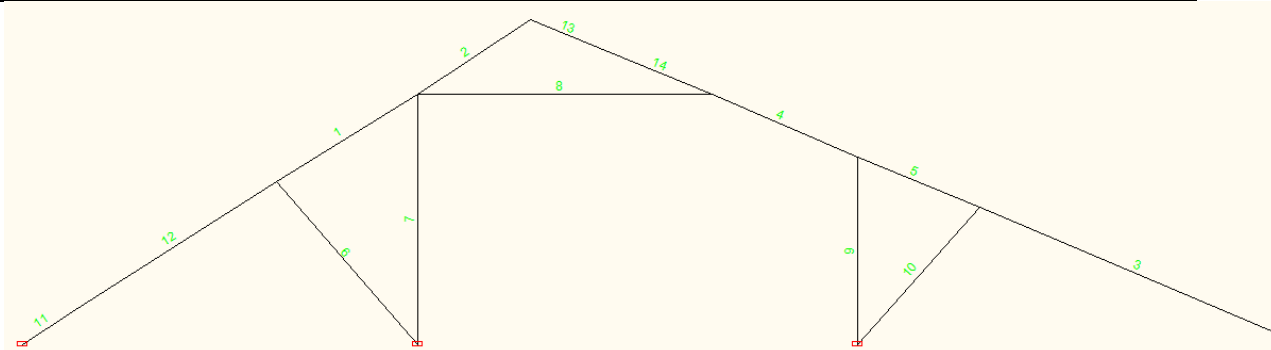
Расчетная схема деревянной стропильной системы крыши
